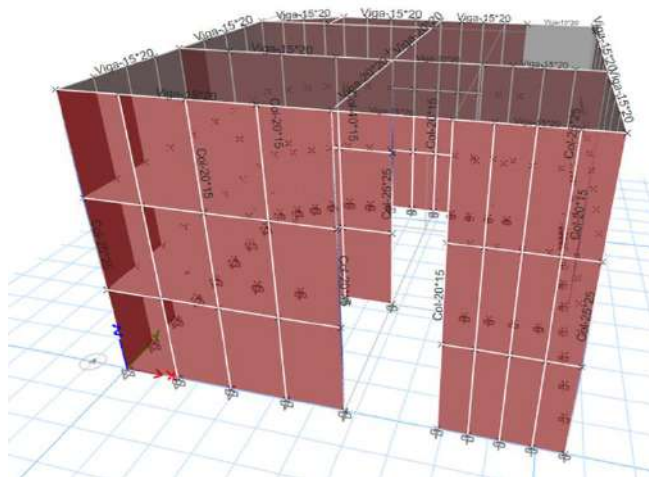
Vista en planta del modelamiento de la vivienda 15
